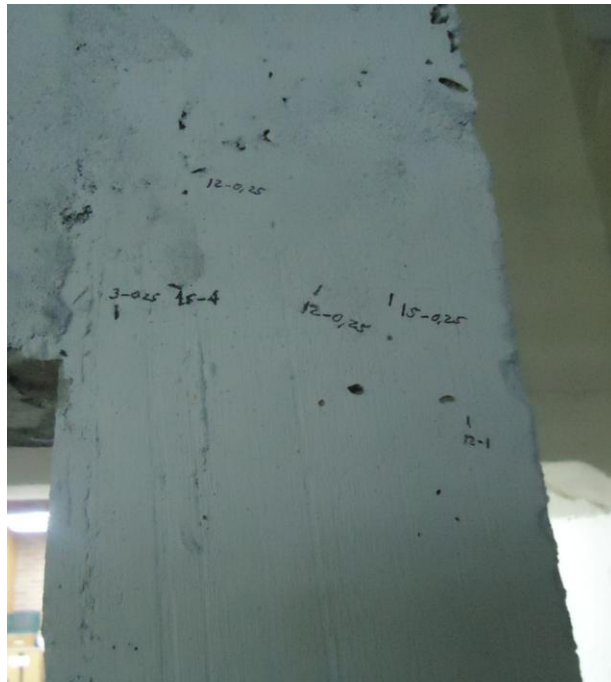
Fisuras generadas en el nudo 2
